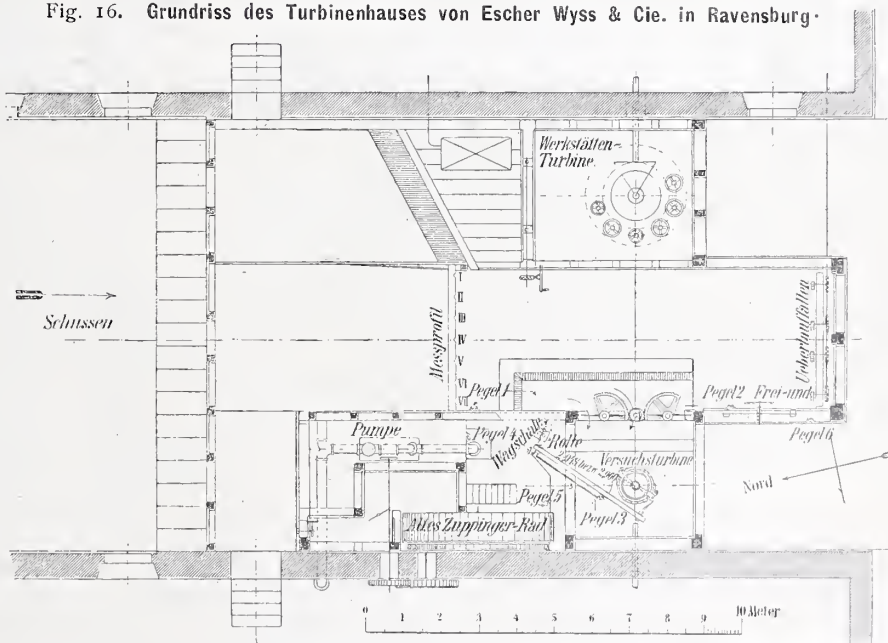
Grundriss des Turbinenhauses von Escher Wyss & Cie. in Ravensburg.
